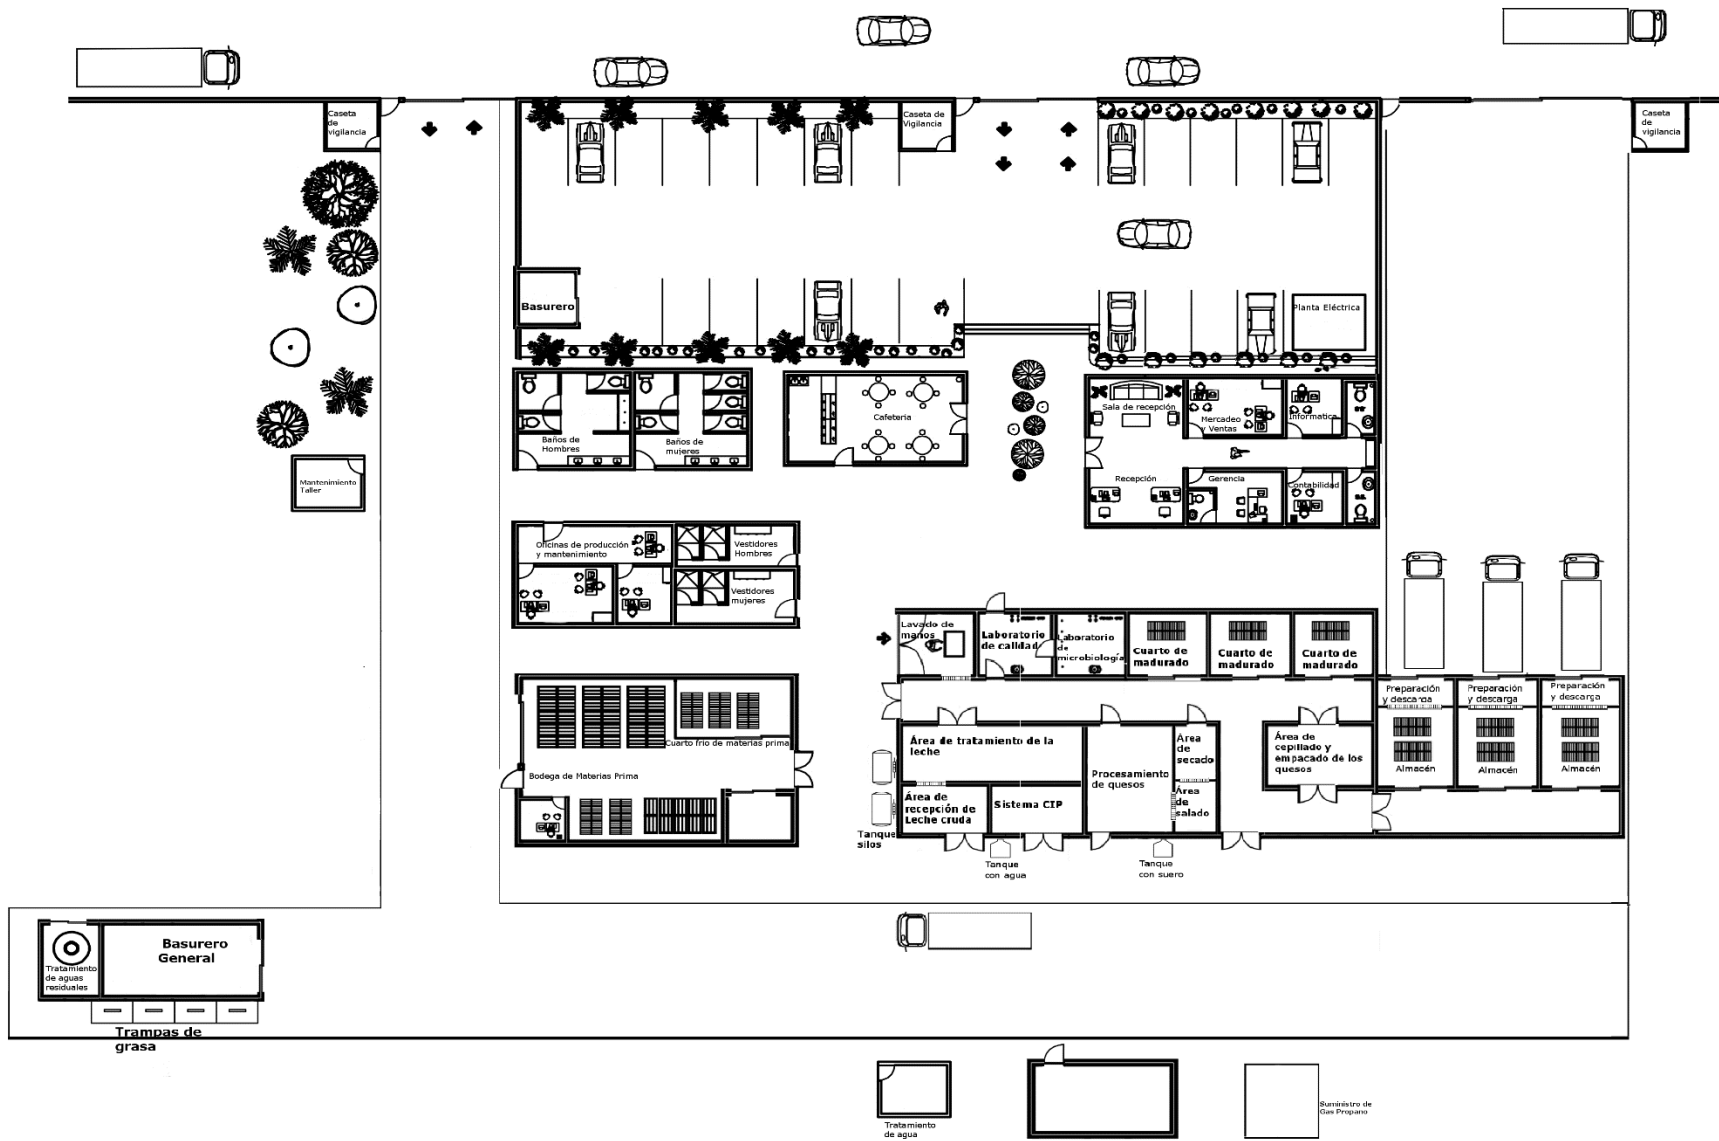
Plano arquitectónico de planta procesadora de quesos gourmet
